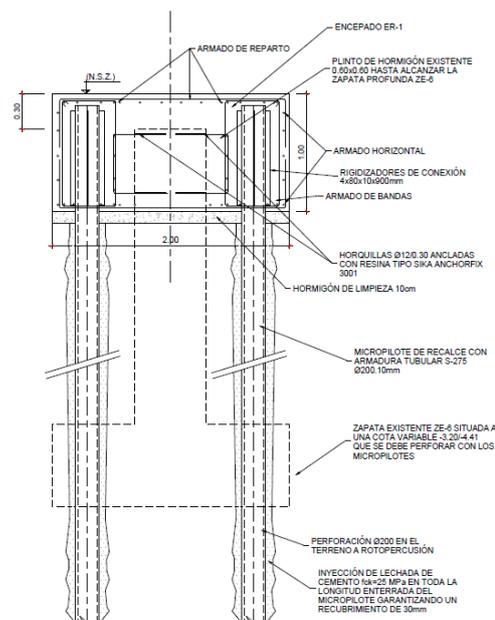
Refuerzo pilar y recalce de cimentación semiprofunda con micropilotes en edificio 1
